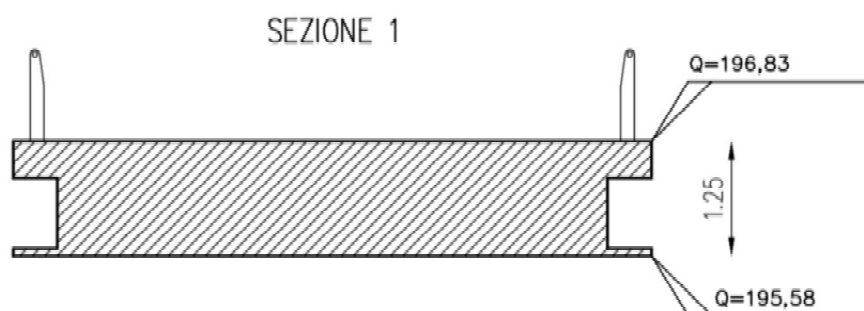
Rilievo Piacentini Ingegneri, sezione trasversale 1 sulla campata lato Brento
